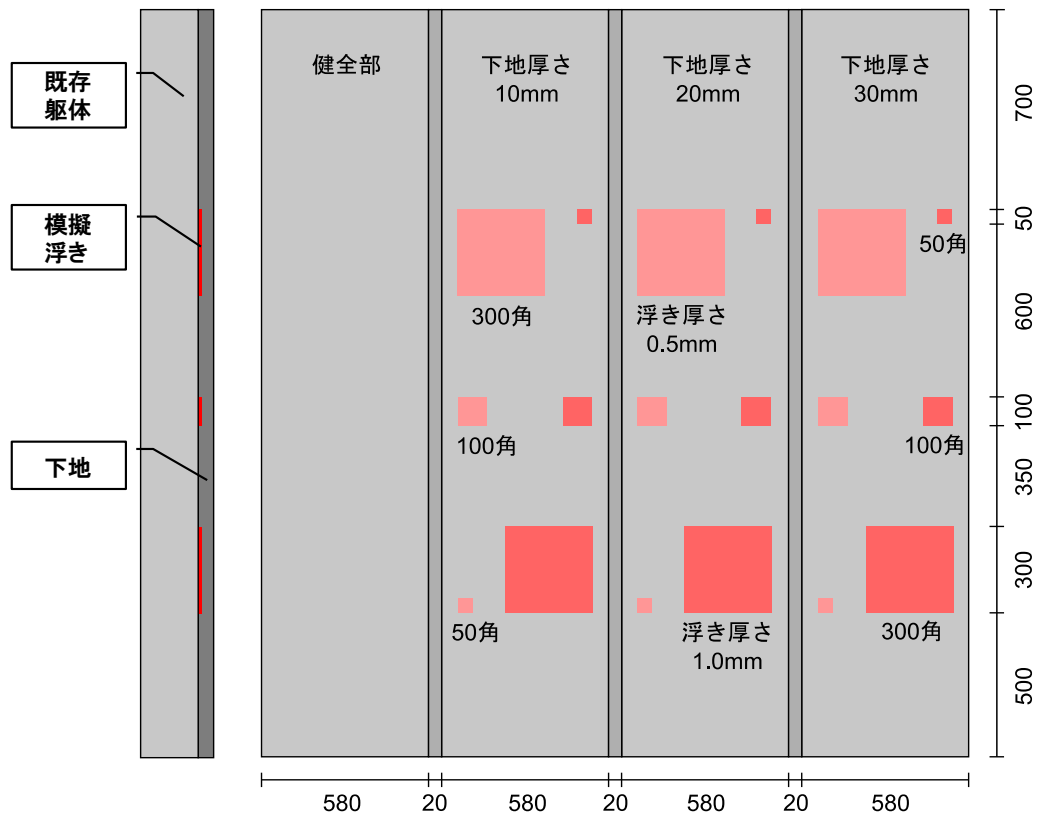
モルタル外壁試験体の模擬浮きの施工計画
